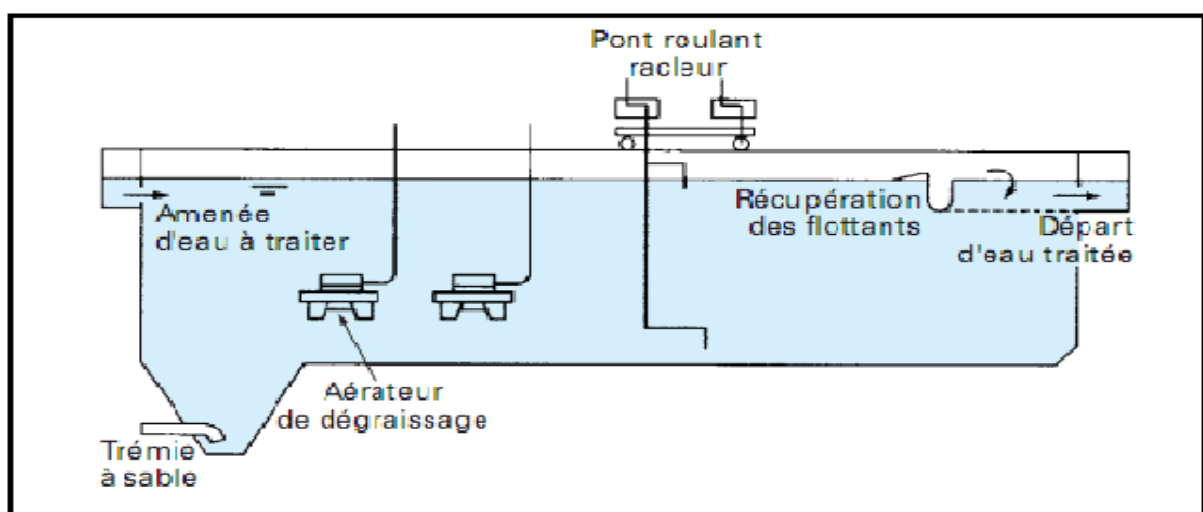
ouvrage de dessablage-déshuilage combinés
